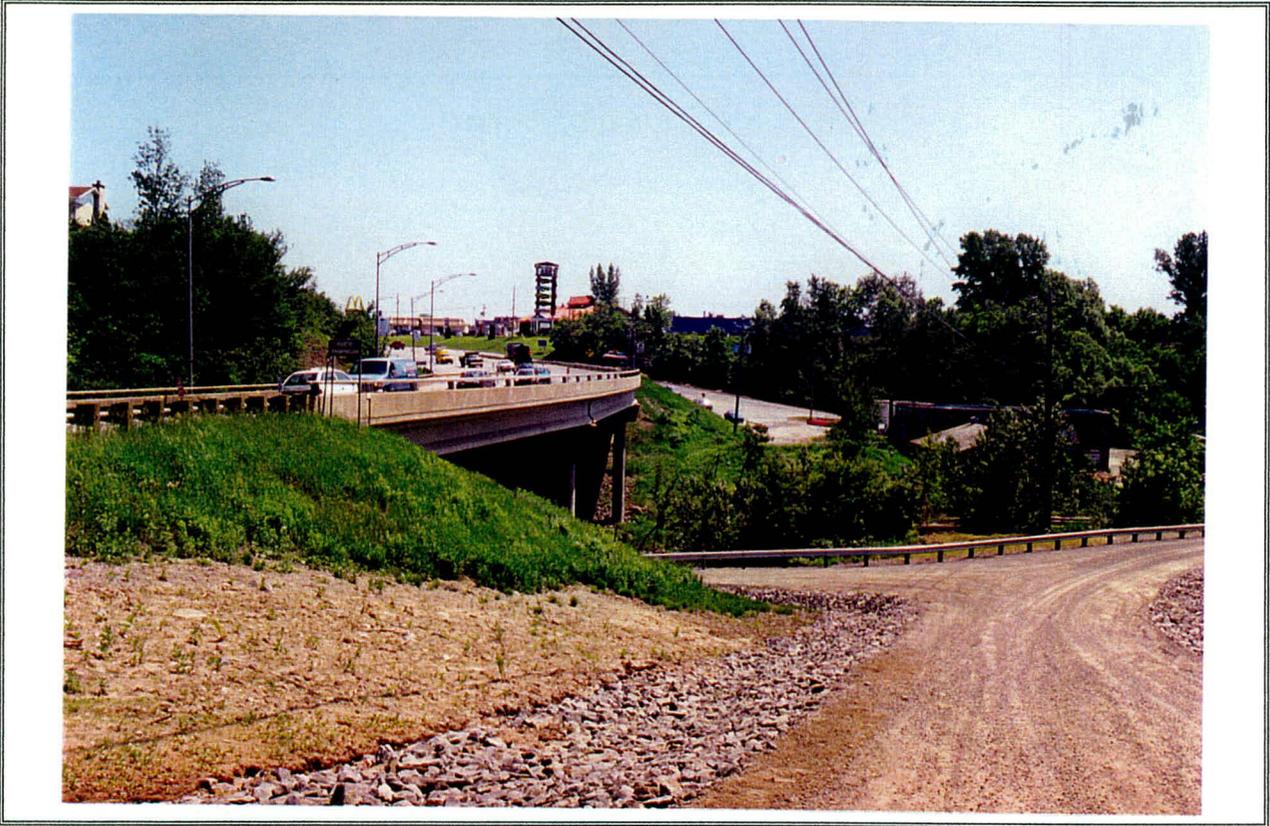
Projet 6372-9613, Shawinigan-Sud (S)
